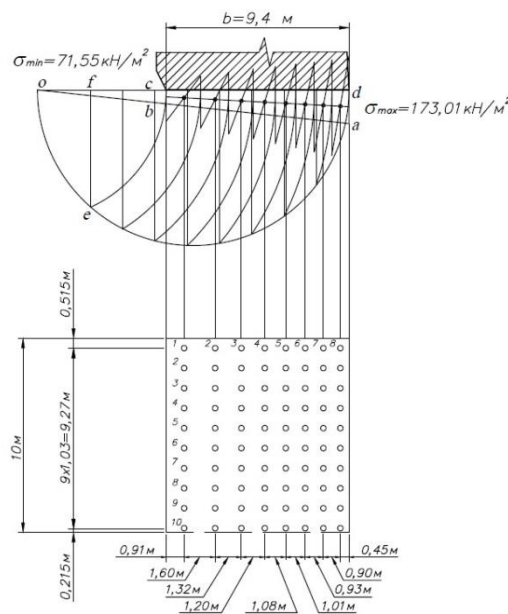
План-схема к размещению свай в поперечном ряду ширины массивной подпорной стенки при угле трения грунта о стенку $\varphi/2$
